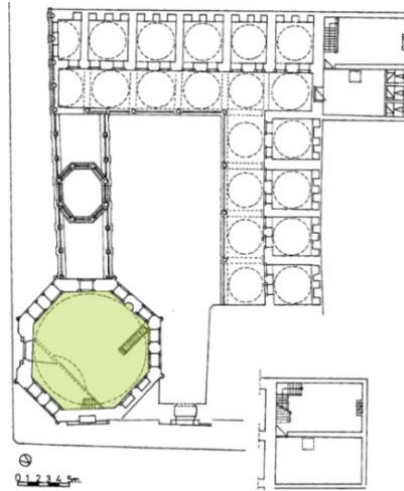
Bursa Hüdavendigâr Medresesi Planı
